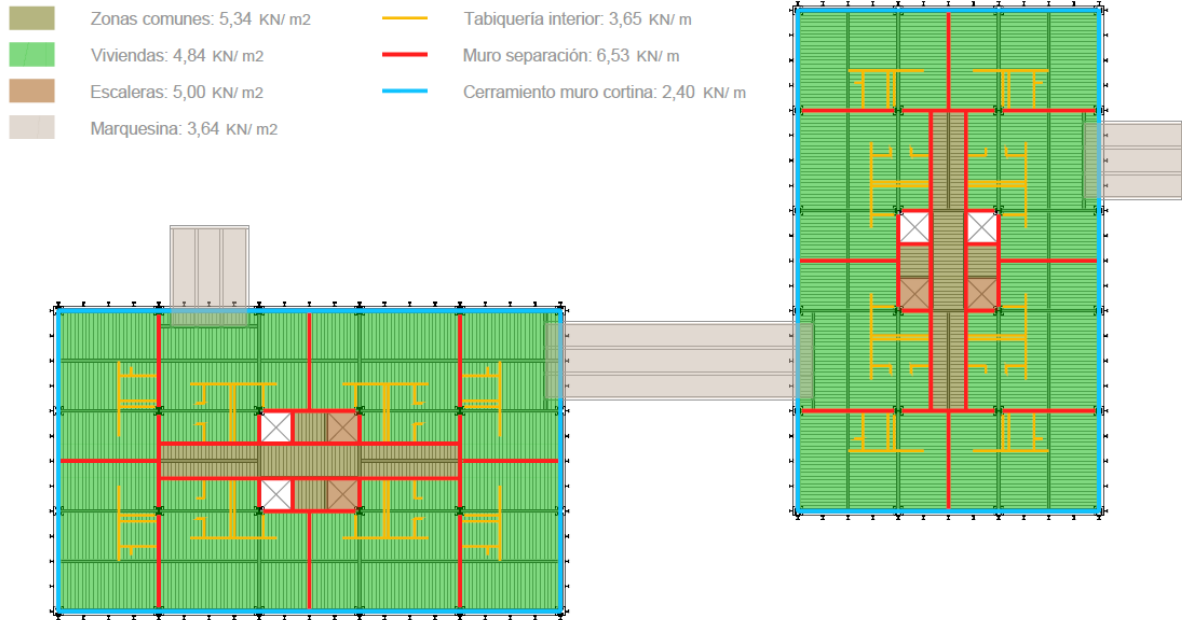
Acciones permanentes en forjado de planta baja. Escala 1:500
